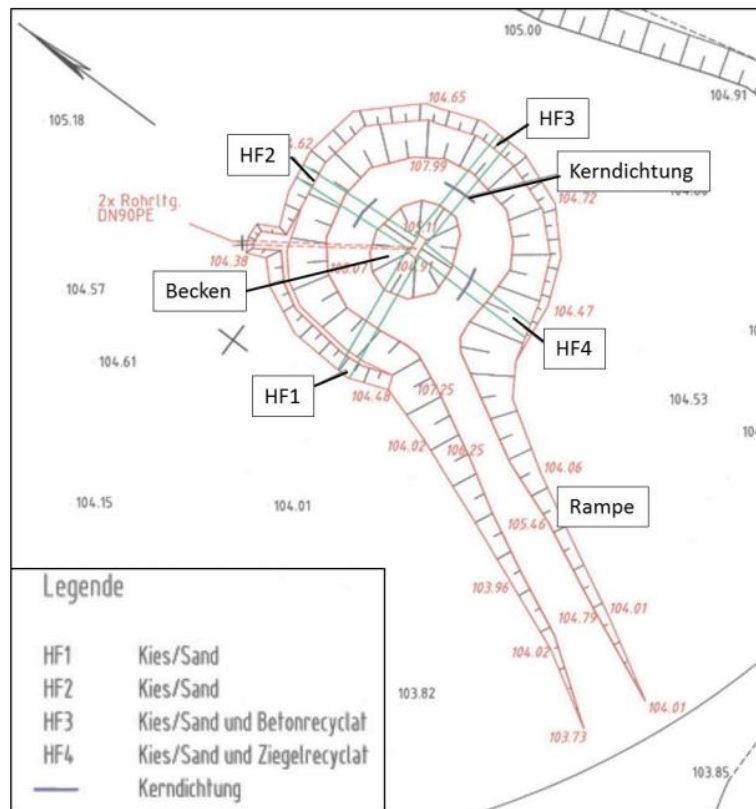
Grundriss des Versuchsdeiches (vgl./11, S.3 /)
